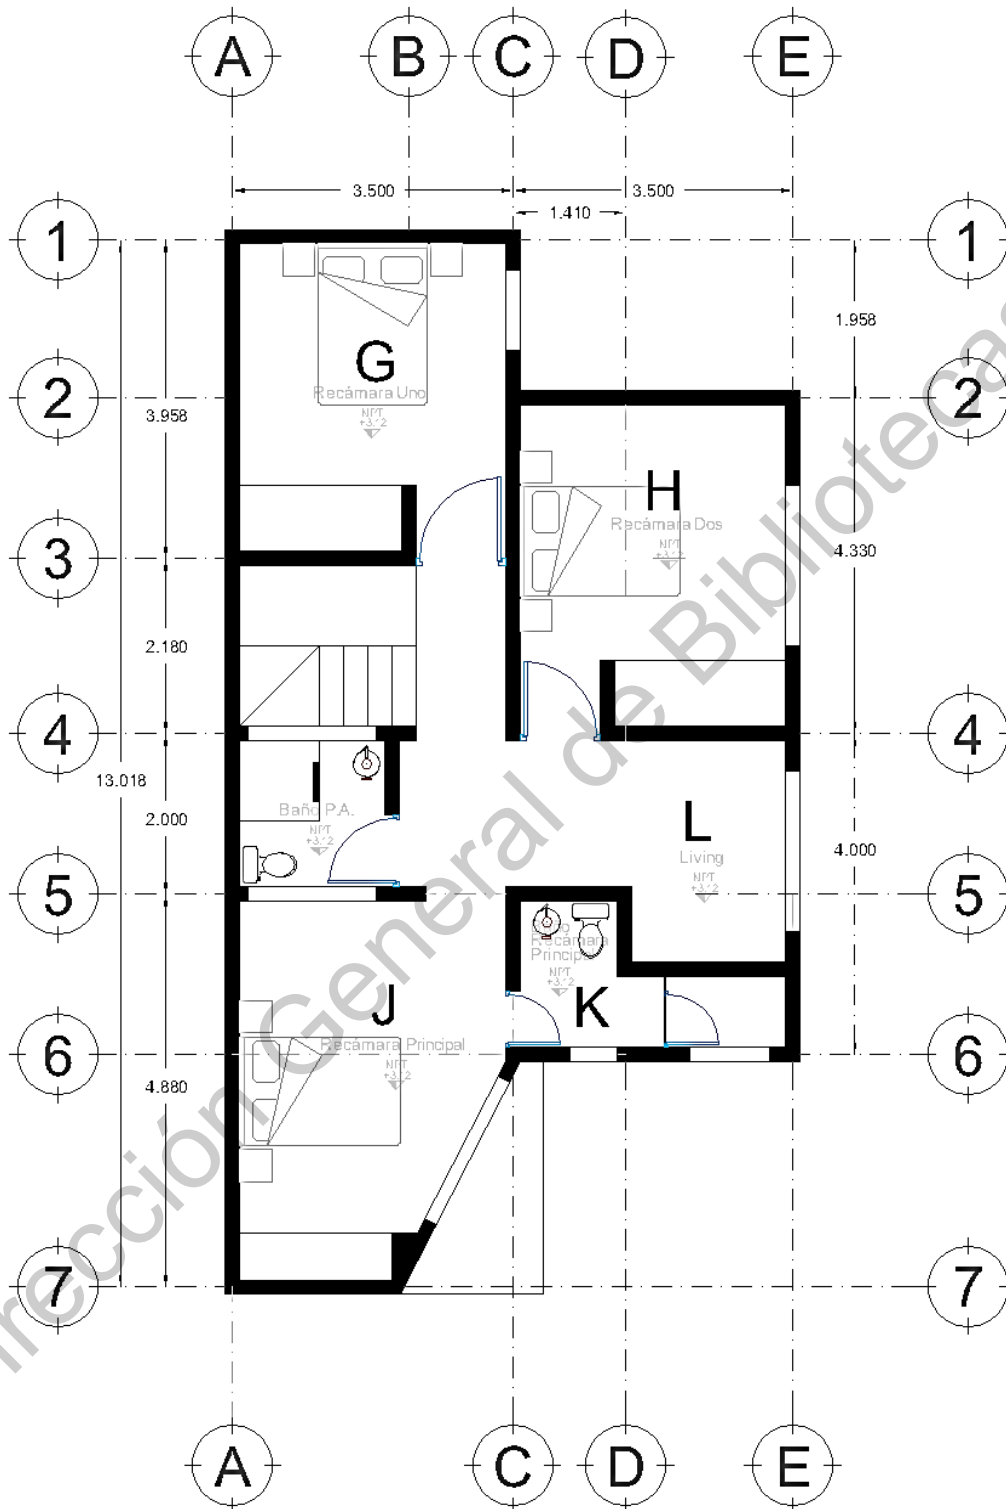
Planta Arquitectónica Alta. Casa Prototipo.
